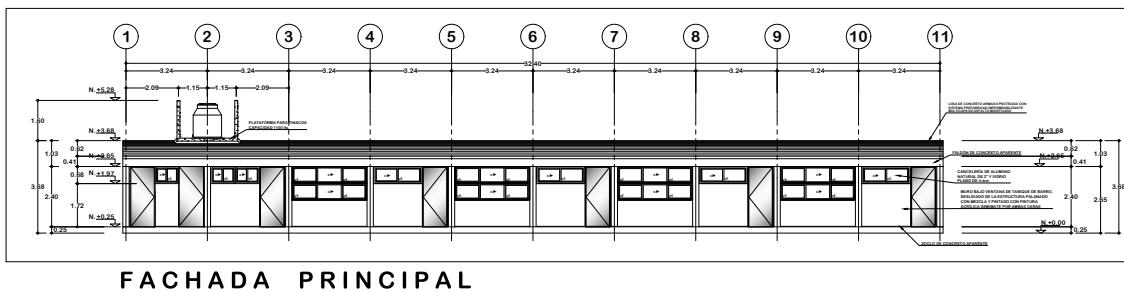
Plantas arquitectónicas de la estructura modificada
